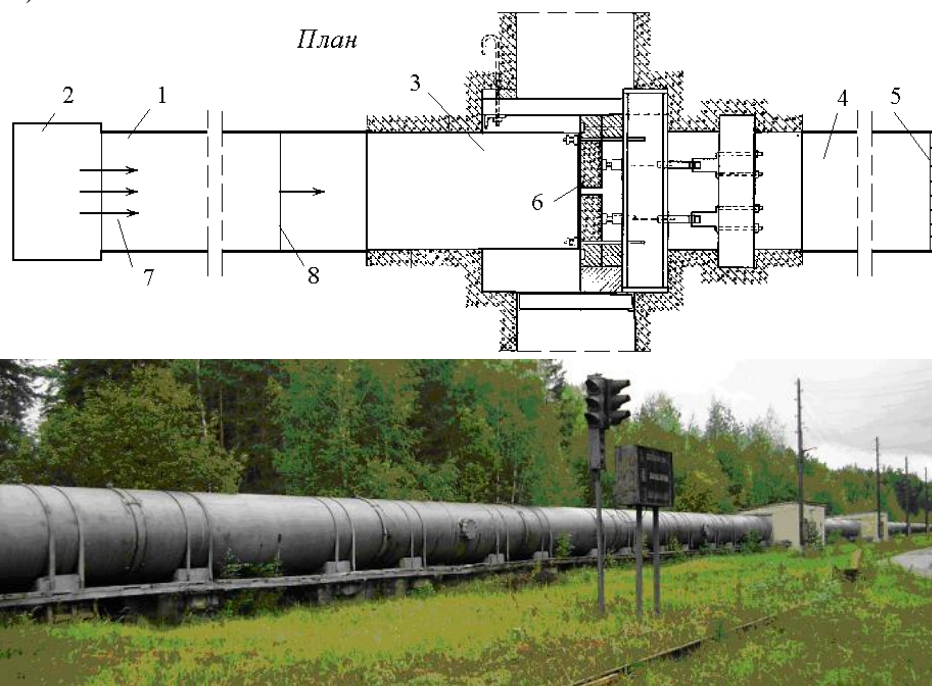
Схема испытаний железобетонных балок в испытательном стенде ударной трубы – генерирующей ударные волны: 1 – волновод; 2 – блок генераторов ударной волны; 3 – стенд для установки объекта испытаний; 4 – оконечная часть волновода; 5 – перфорированный отражатель; 6 – опытная конструкция, установленная для испытаний на действие отраженной ударной волны; 7 – струи сжатого или горящего газа; 8 – сформировавшийся фронт ударной волны
